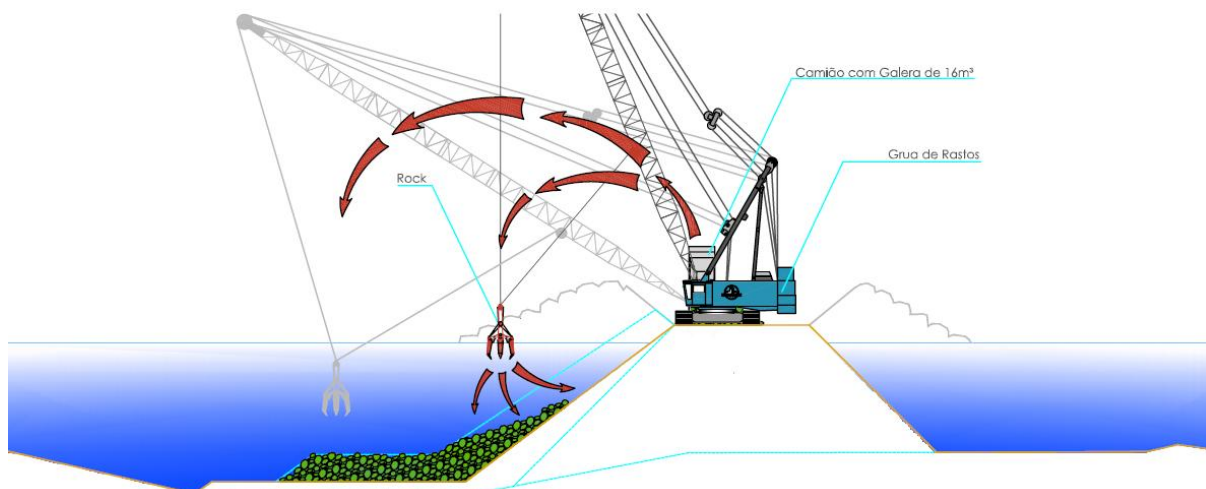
Construção da primeira subcamada, colocação de enrocamento por meios terrestres, esquema em corte longitudinal 1. (ETERMAR – Engenharia e construção S.A.)
